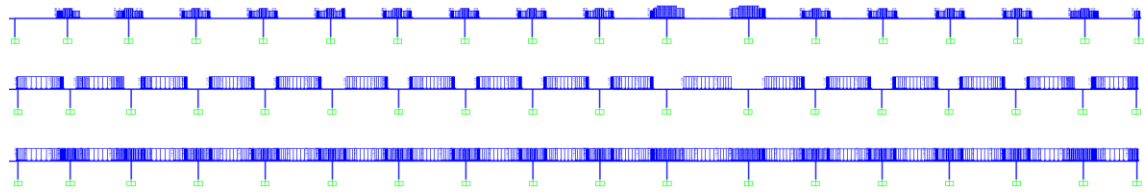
Cargas por peso propio de losa inferior (arriba), prelasas (abajo) y losa superior (abajo).
